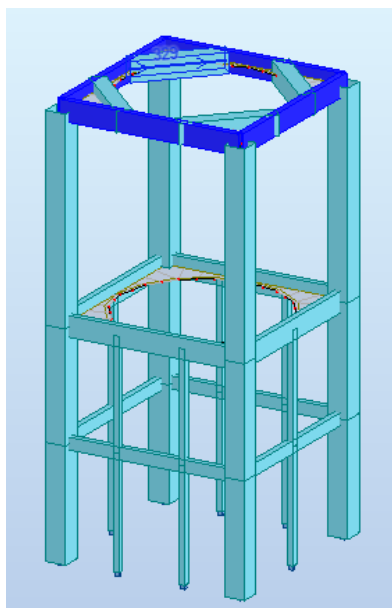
Vigas principais 2º piso - 1,5 m x 0,8 m
